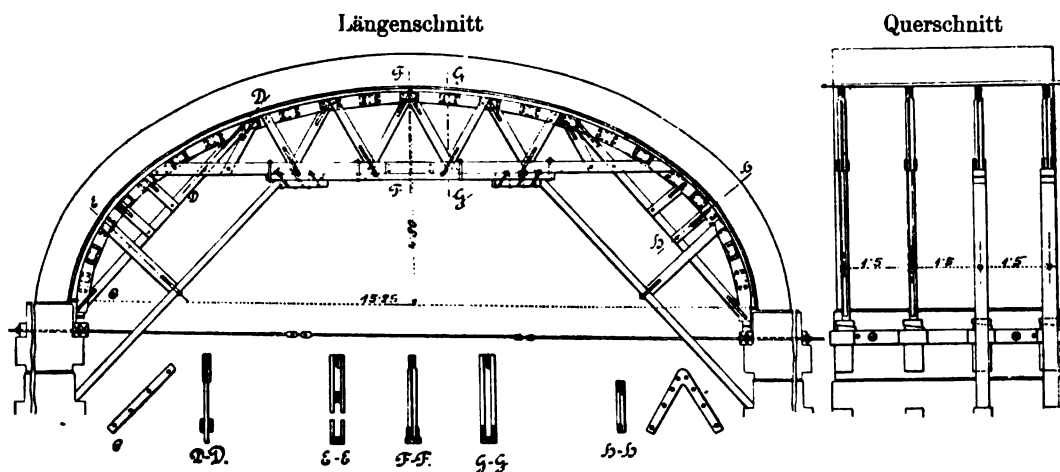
Lehrgerüst des Betonviaduktes in Cannington.
